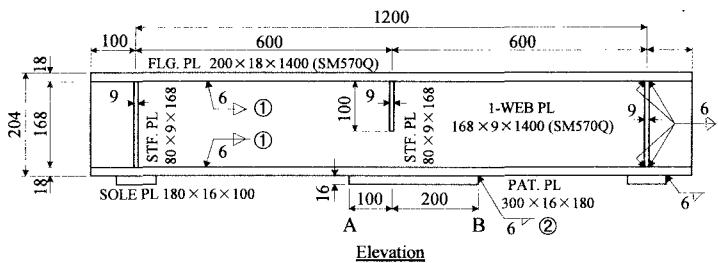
あて板付き桁試験体の形状と寸法 (単位は mm)
